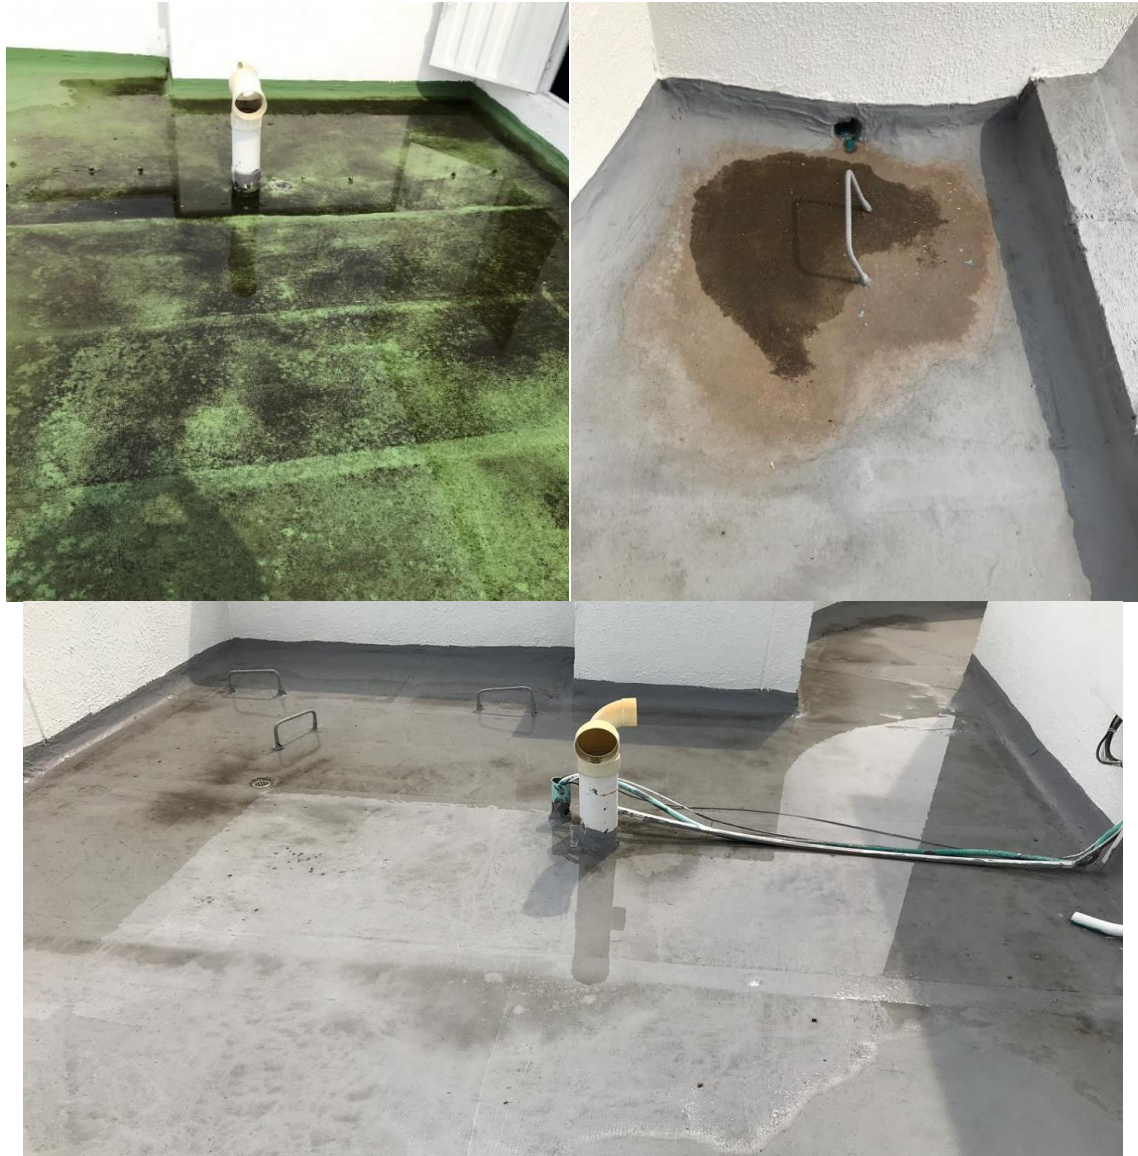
a) Corrosión en el acero de refuerzo de placa superior del tanque de almacenamiento de agua potable Conjunto Residencial Villa Cañaverál. b) Corrosión en el acero de refuerzo de placa superior del tanque de almacenamiento de agua potable visto desde otro ángulo.
